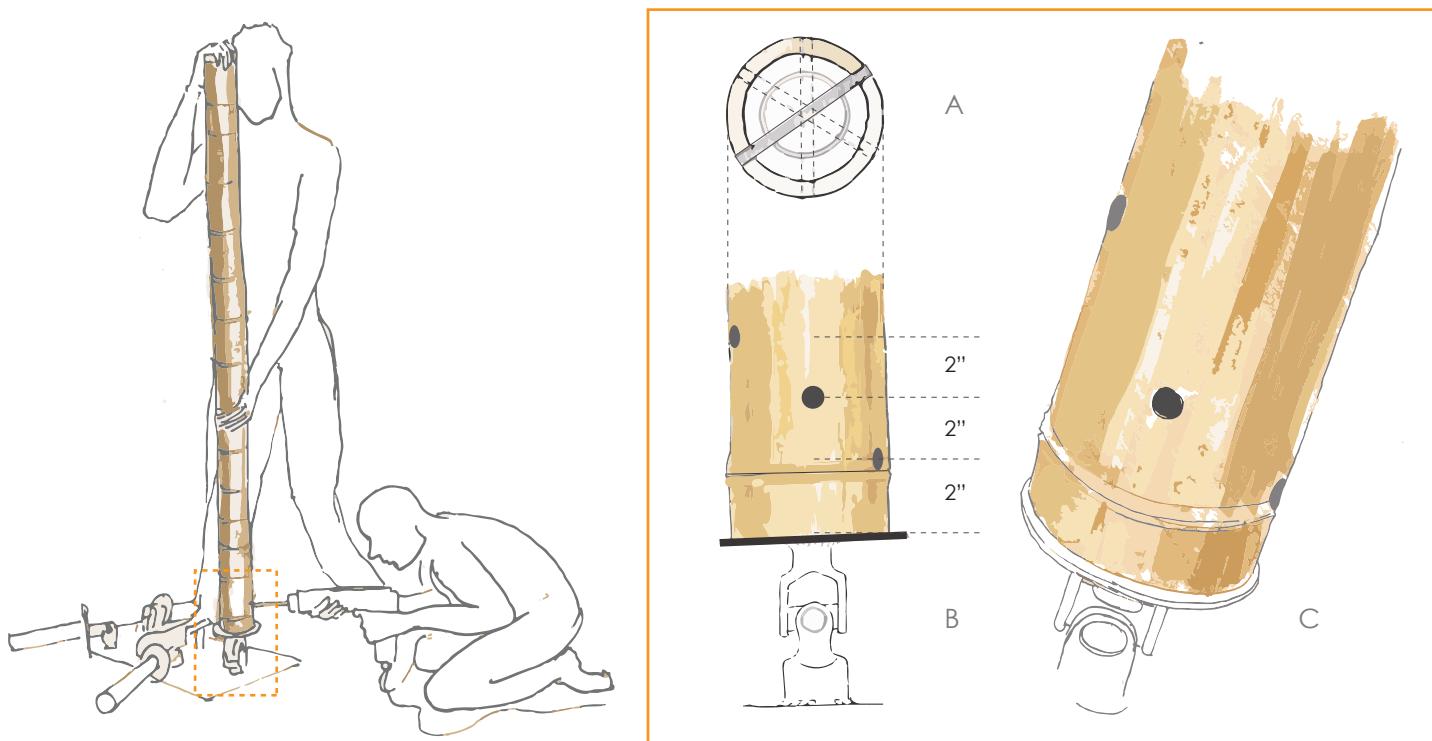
Detalle de fijación con esparrago galvanizado. A) Vista en planta, B) Vista en alzado y C) Vista en isométrico.
